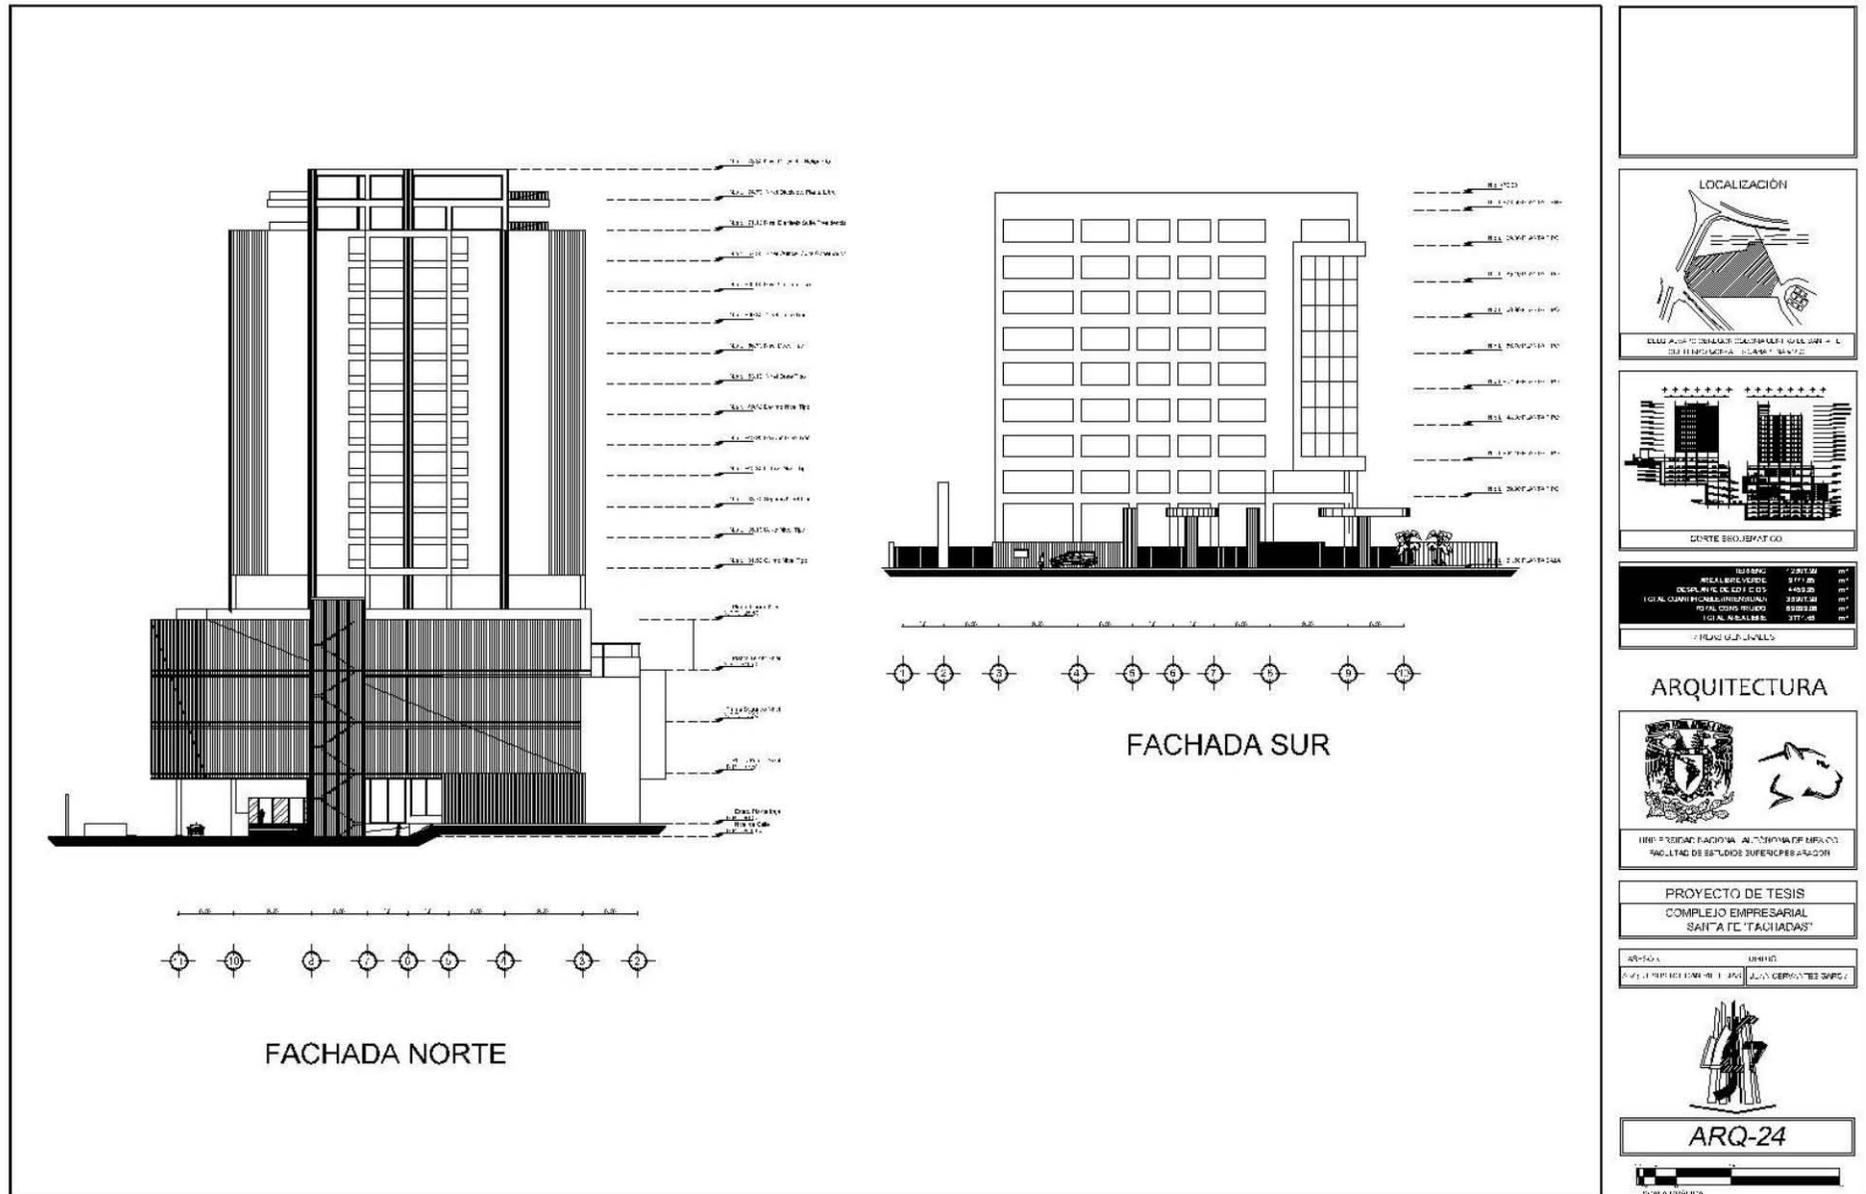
Plano ARQ-24; Fachada Norte Hotel y Centro Comercial, Fachada Sur Oficinas. Edición propia.
